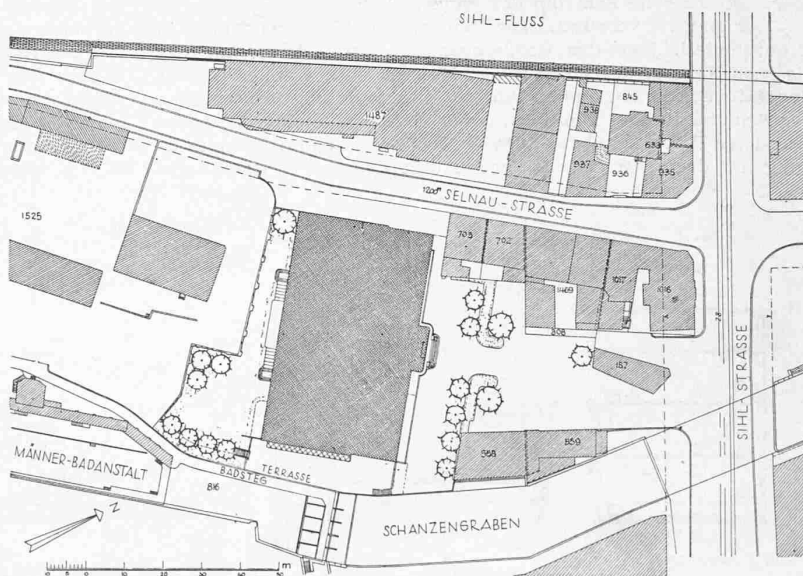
Lageplan 1:1800 des Zürcher Hallenbades (kreuzweise schraffiert)
